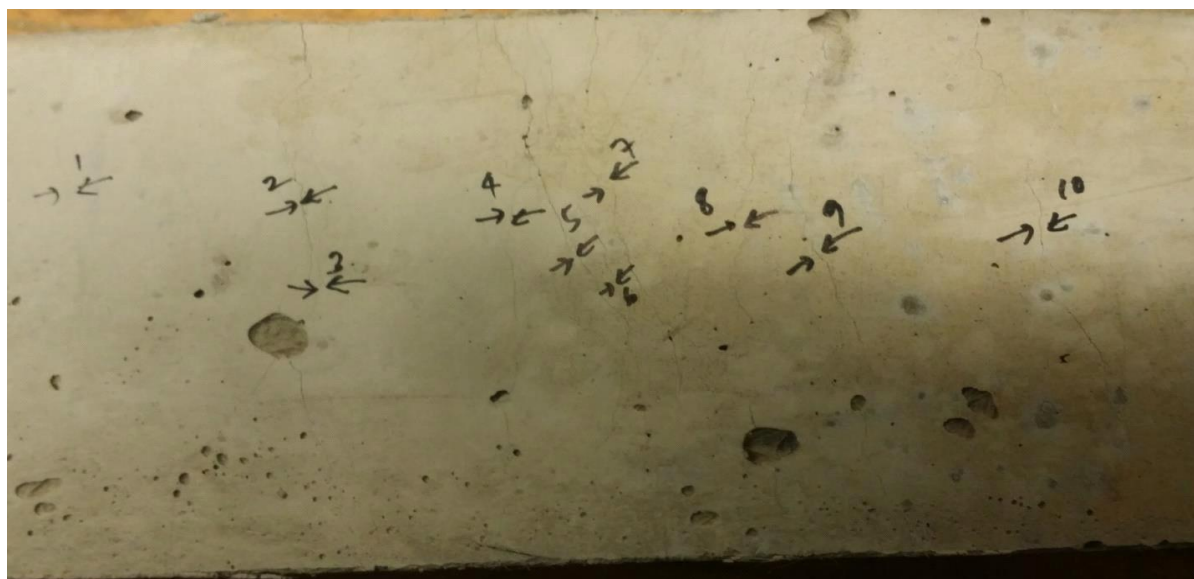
Типичный образец из ЕСС с добавлением бактерий, подвергавшийся предварительному нагружению, с множественными трещинами
